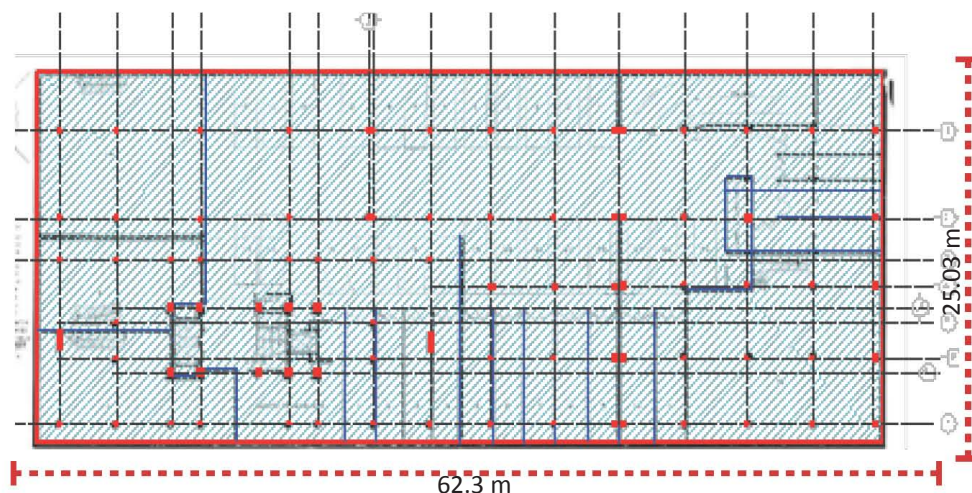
Plano de sótano. Modificado para fines académicos. En éste plano se marca con rojo la estructura y en sombreado cian las áreas ocupadas Fuente: creación propia
